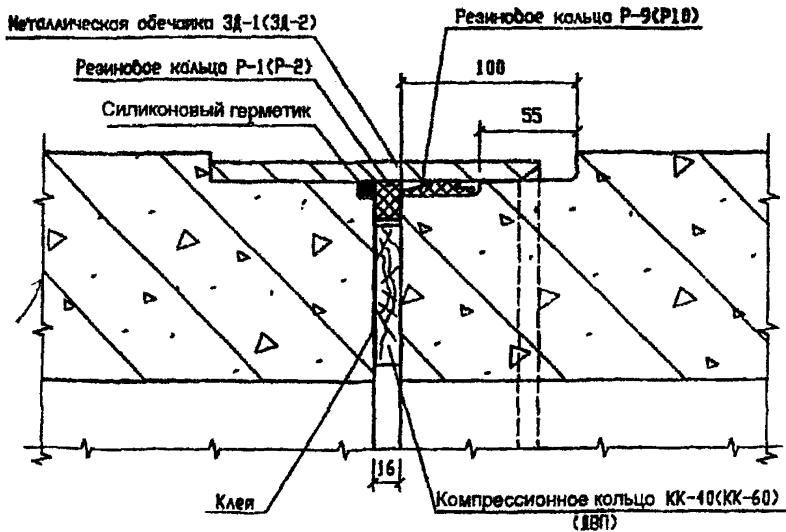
Схема стыкового соединения железобетонных труб ТСМ 40.200.2, ТСМ 60.200.1 и ТСМ 60.200.2
